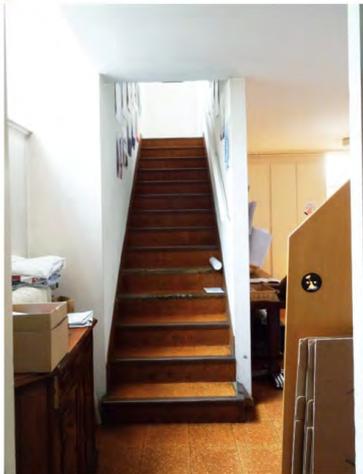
Escalier d'accès aux bureaux de la mezzanine.
